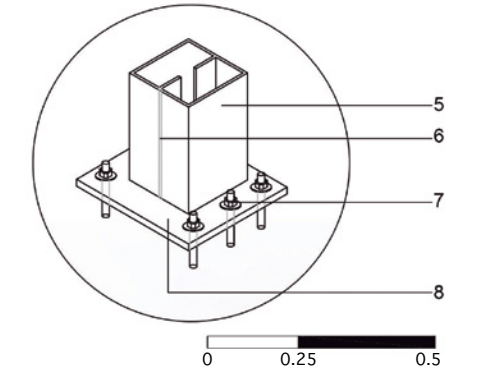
Corte por fachada del proyecto + Detalles constructivos.
